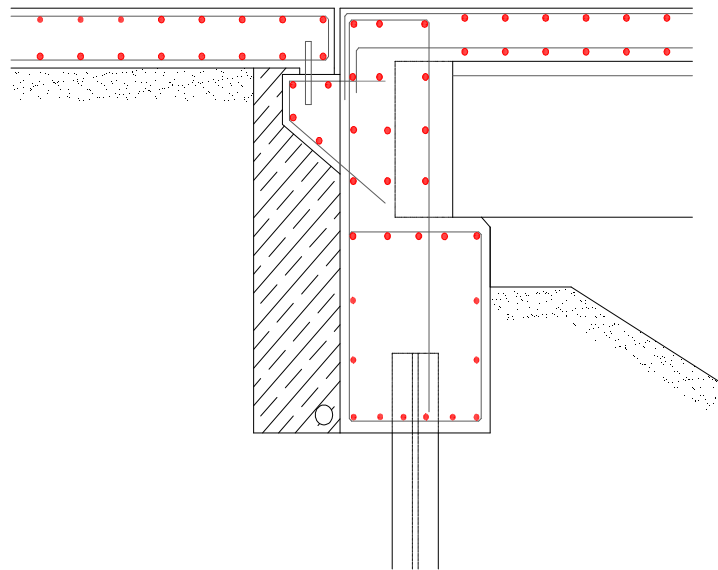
Connessione sovrastruttura – spalla, *schema 6
